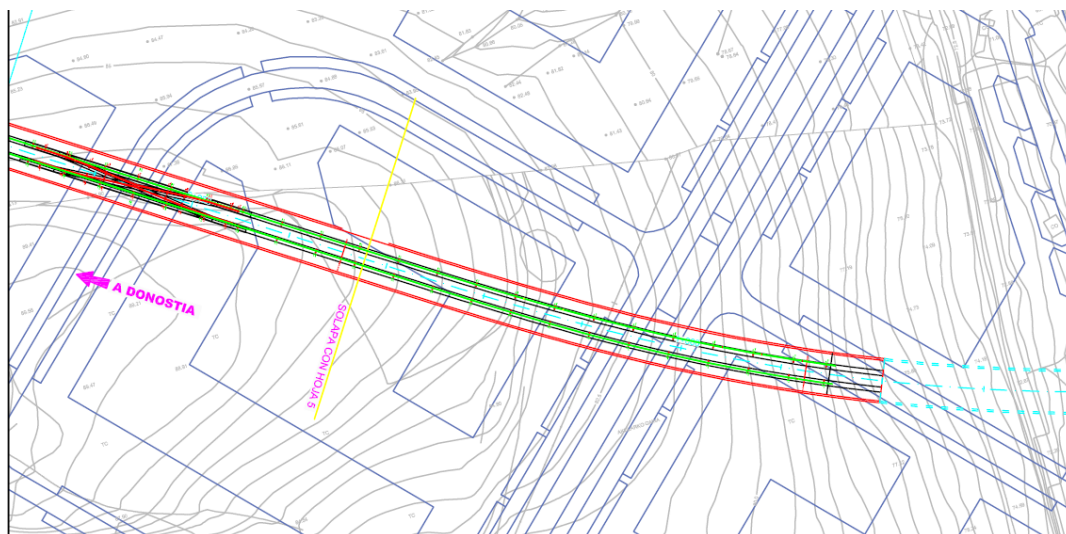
Planta de electrificación fin de línea Altza (fuente: proyecto as-built)
